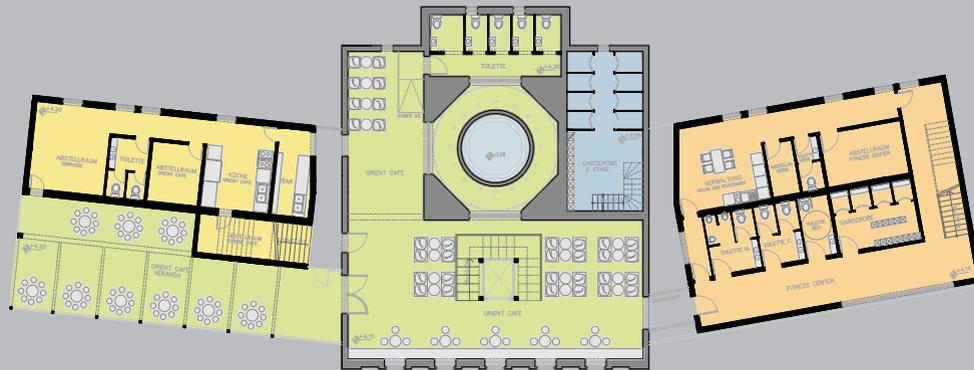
Grundriss 1. Obergeschoss\_Funktionen
